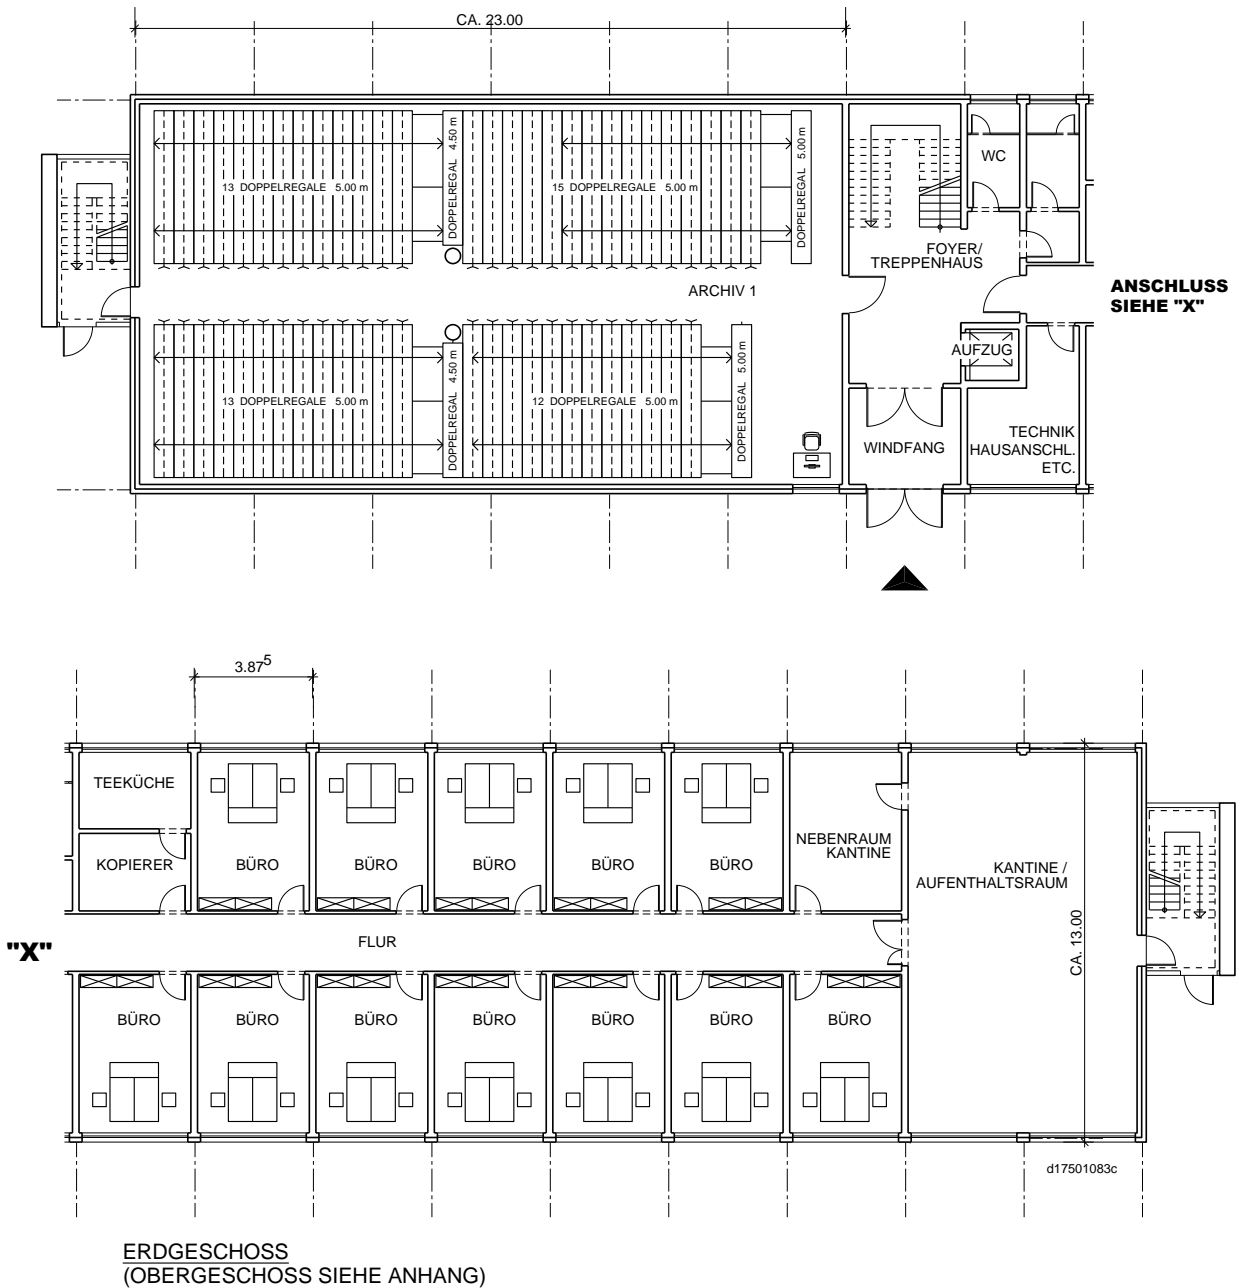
Bürogebäude (Grundriss Erdgeschoss)
